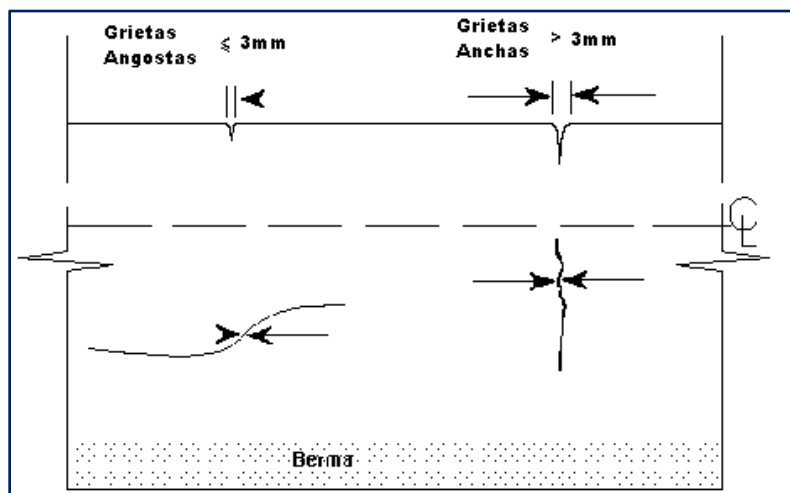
Esquema de Grietas Lineales, Fuente: Instructivo de Inspección Visual de Caminos Pavimentados, 2010.
